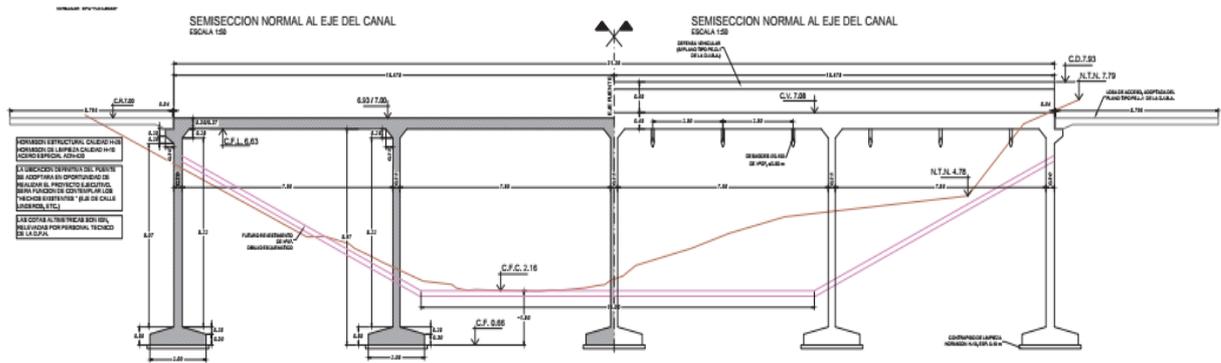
Sección del puente a construir, normal al eje del canal. Fuente: Departamento Estructuras-DPH
